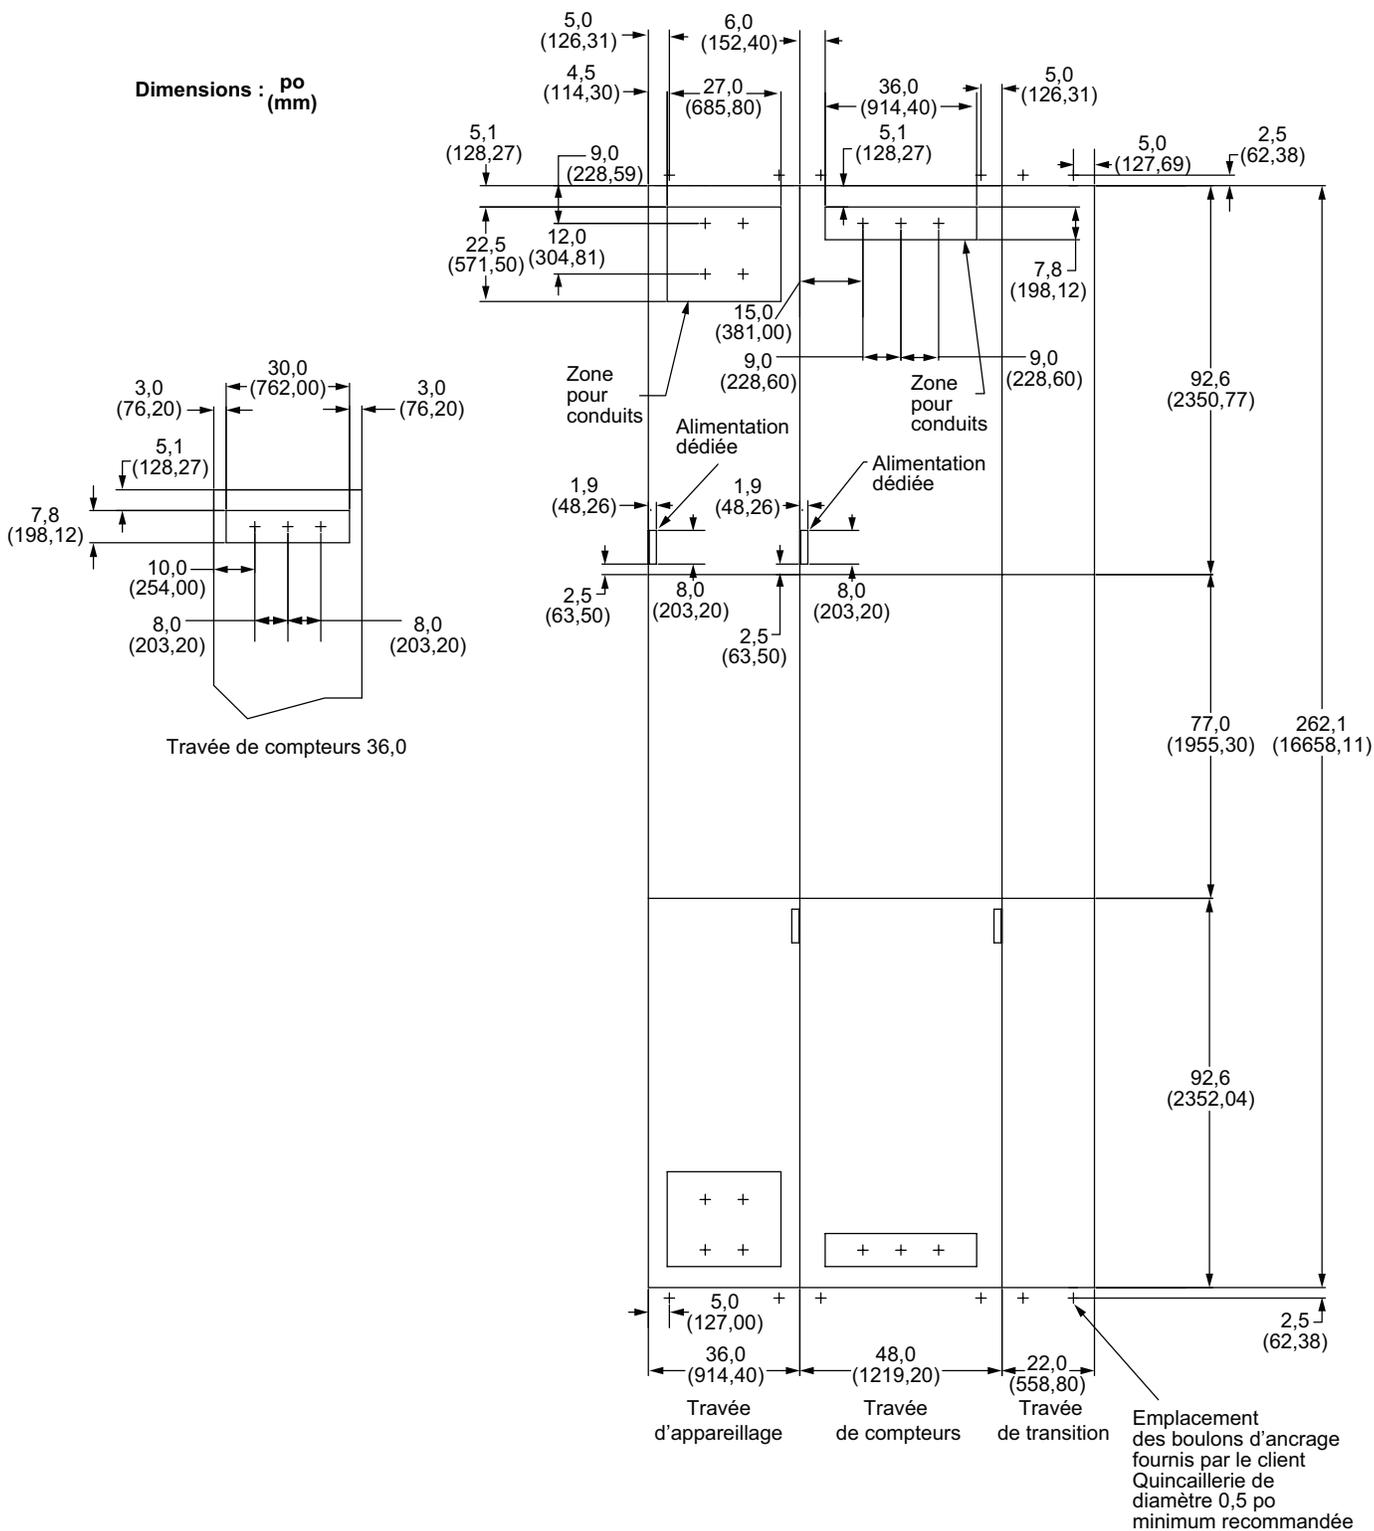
Plan de sol typique à allée commune (pas pour la construction)
